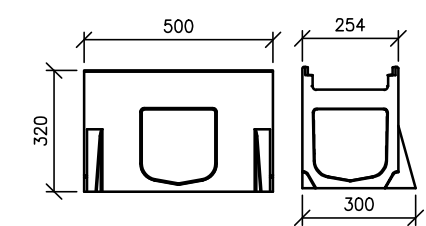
DETAIL ULOŽENÍ MONOLITICKÉHO ŽLABU TYPU DM
